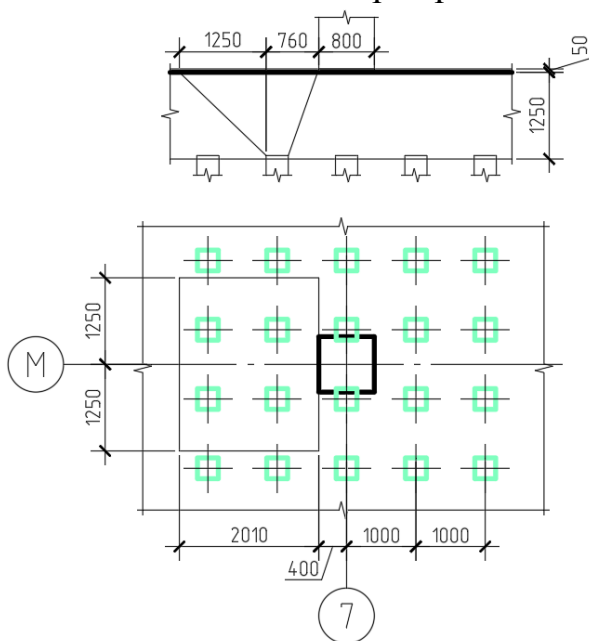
Схема к расчету плитного фундамента на продавливание
